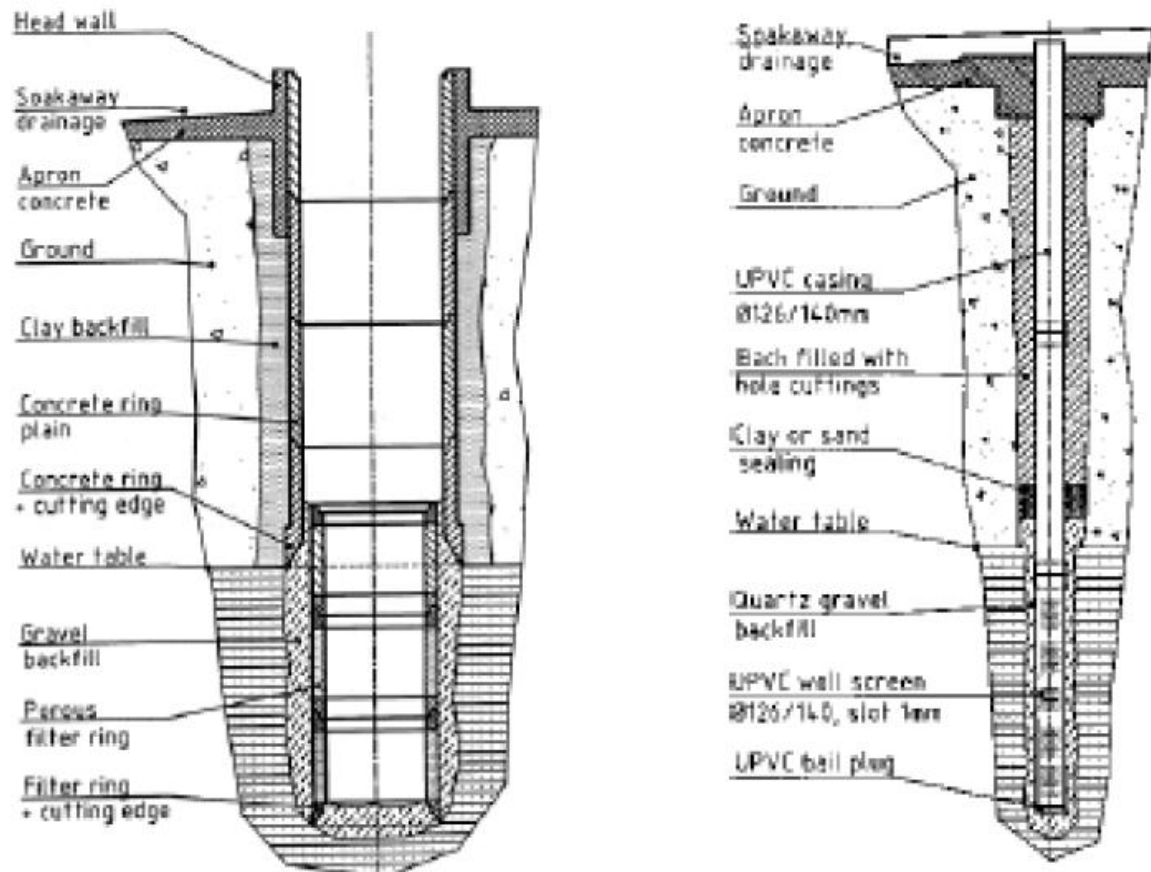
Pozo excavado / Pozo perforado (Baumann, 2000).
